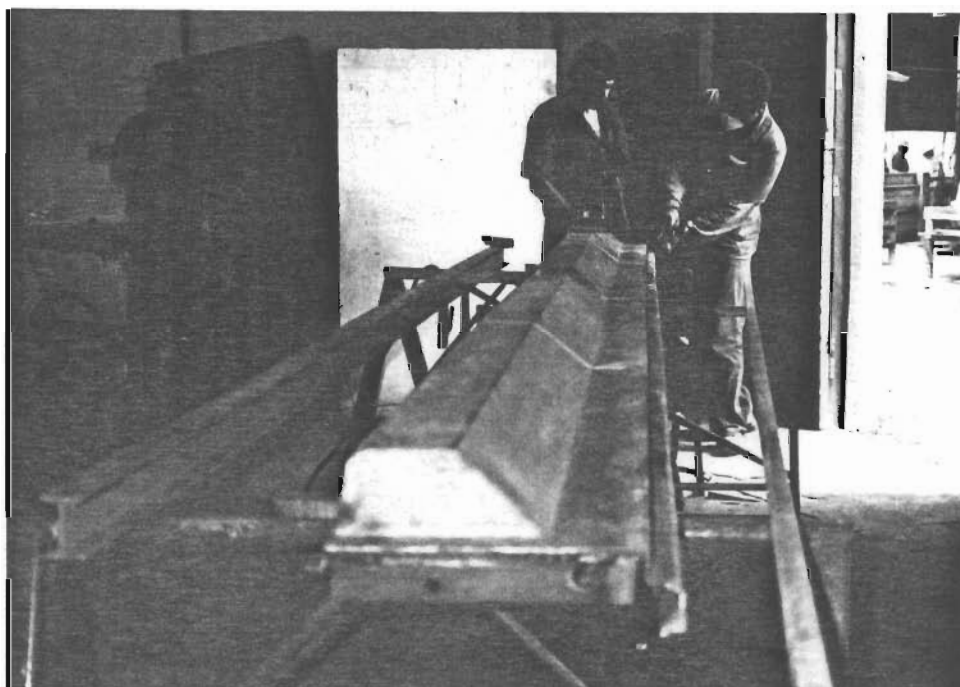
Fôrma metálica de viga de cobertura desmontada em manutenção
